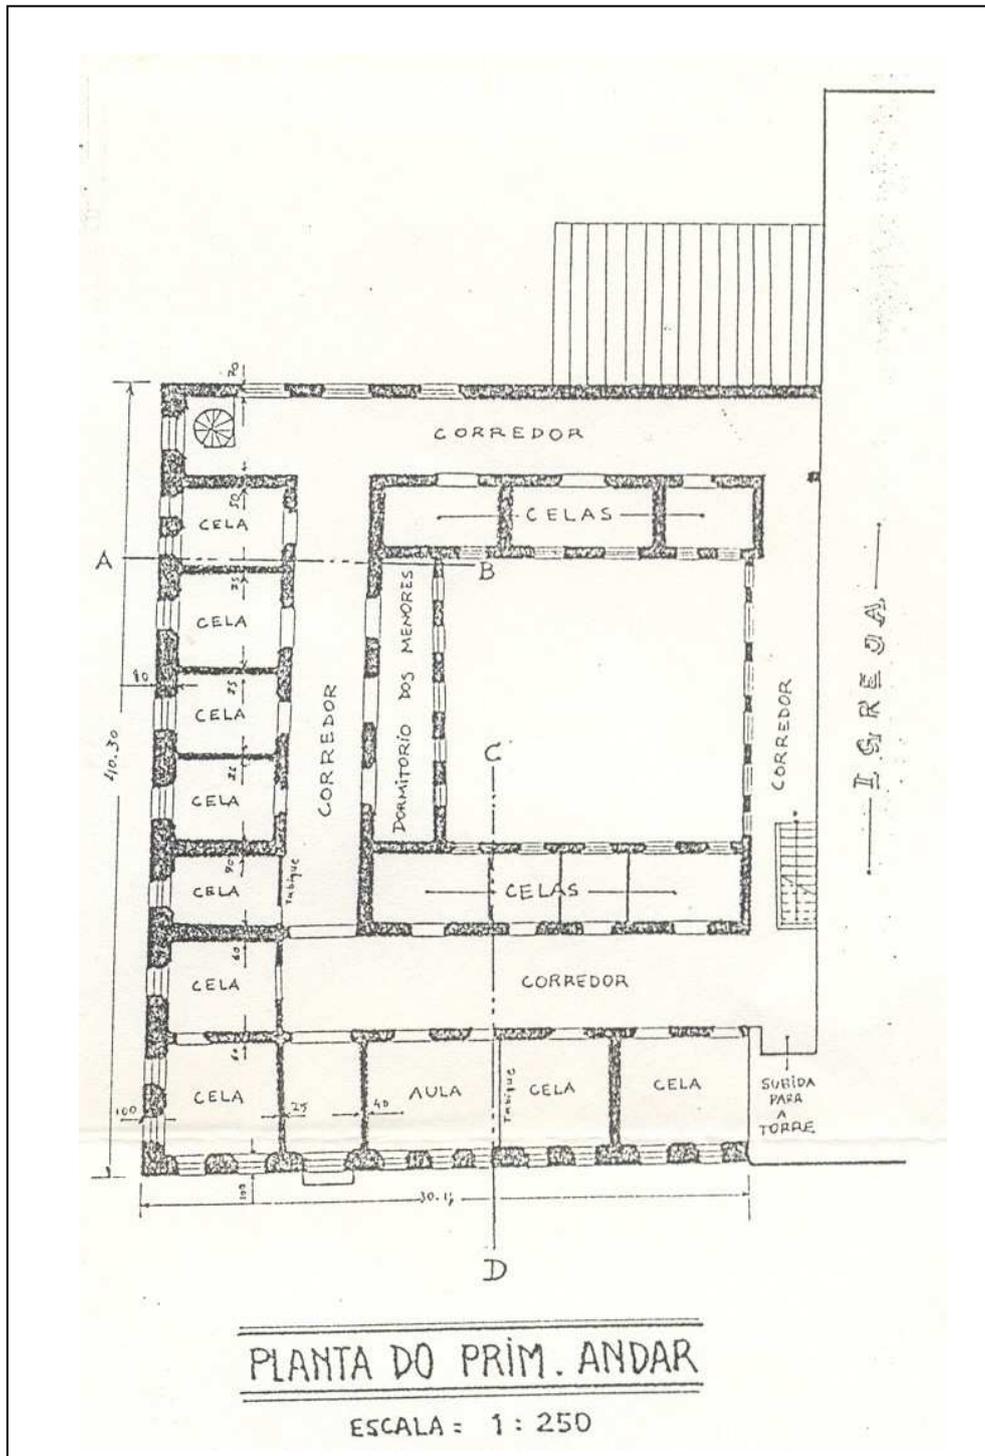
Planta baixa do pavimento superior do Convento, 1931.
